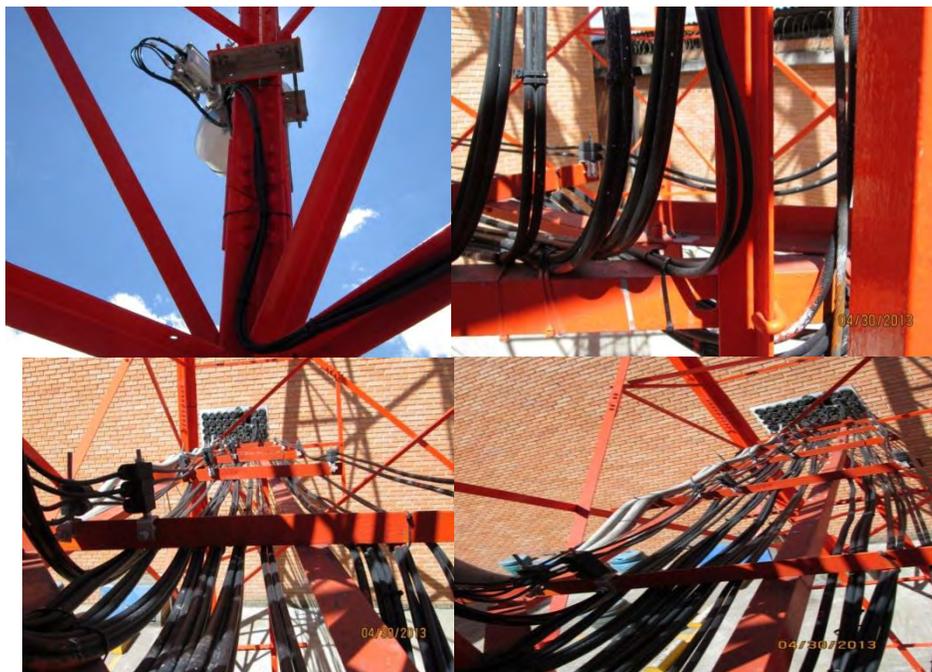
Recorrido y conexión cable IF por la escalerilla vertical y horizontal. Fuente: propia de este trabajo
